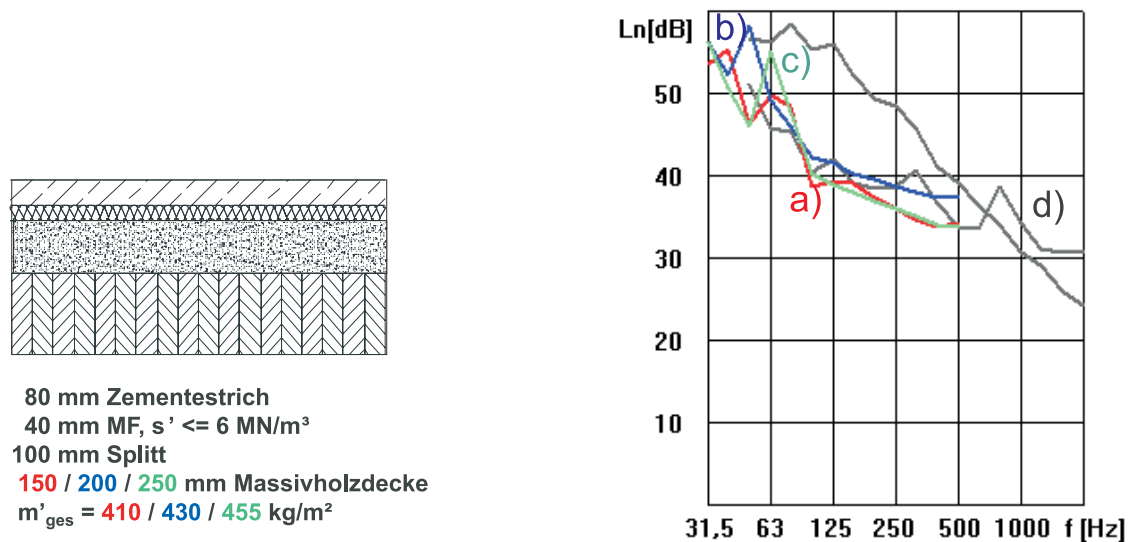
Vergleich unterschiedlicher Rohdeckenstärken: a) Berechnung mit 150 mm Brettschichtholzelement b) Berechnung mit 200 mm Brettschichtholzelement c) Berechnung mit 250 mm Brettschichtholzelement d) Messwerte Zementestrichaufbau auf einer 160 mm Stahlbetondecke
